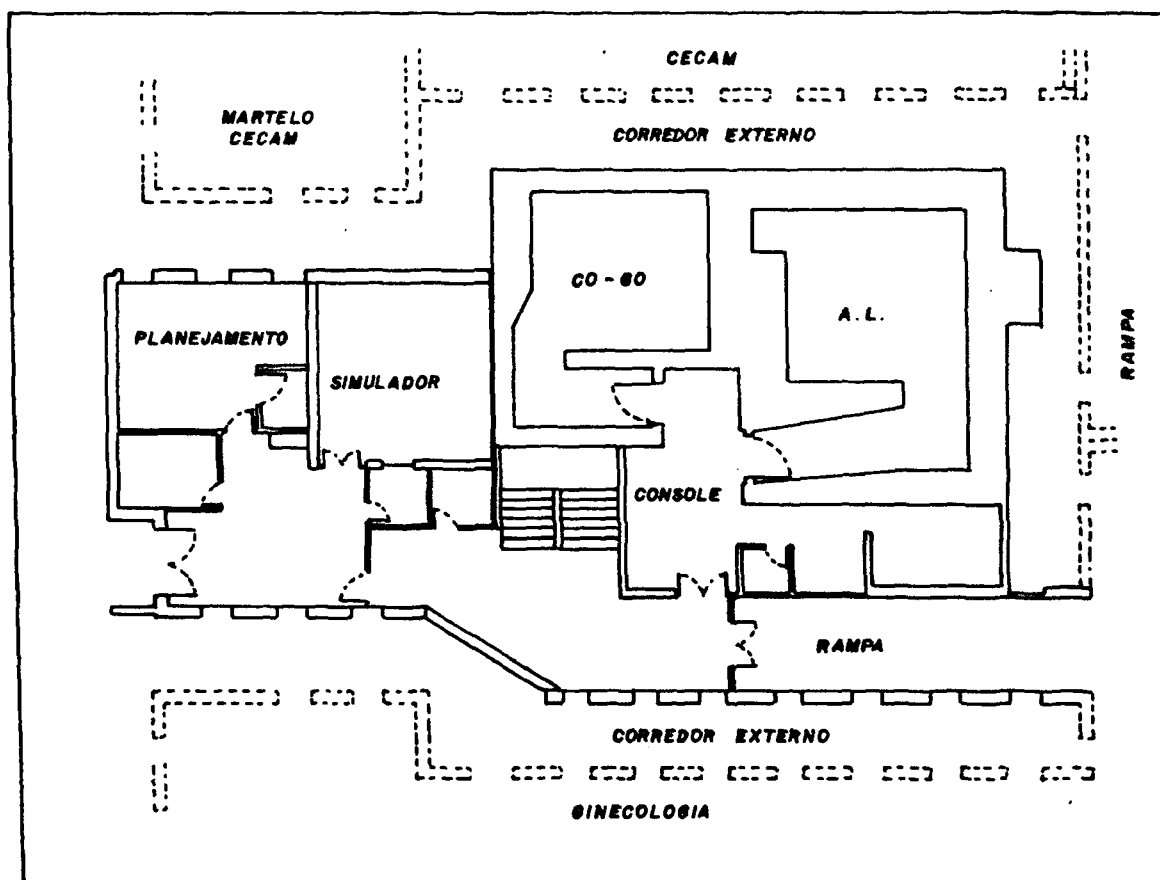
PLANTA BAIXA DO BLOCO J - CAISM (ÁREA DO RXT)
